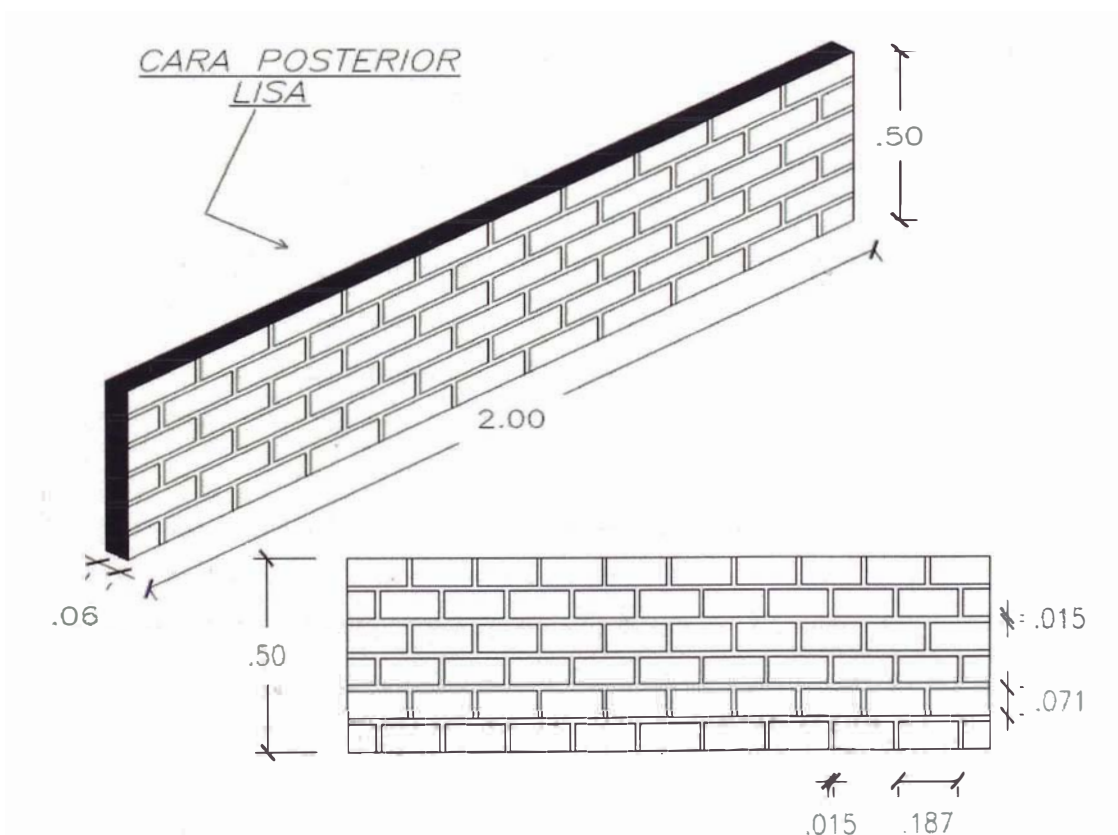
Detalle de panel prefabricado de concreto armado
